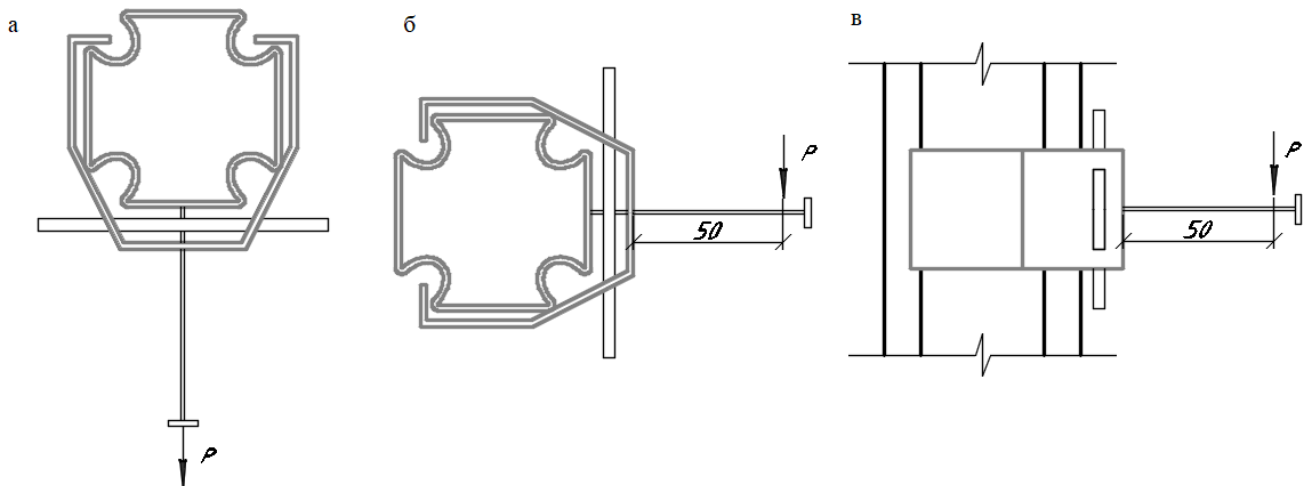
Расчетные схемы при определении несущей способности подвесов: (а) – определение предельной нагрузки на отрыв подвеса, (б) – определение предельной нагрузки на срез поперек стержня профиля, (в) – определение предельной нагрузки на срез вдоль стержня профиля
